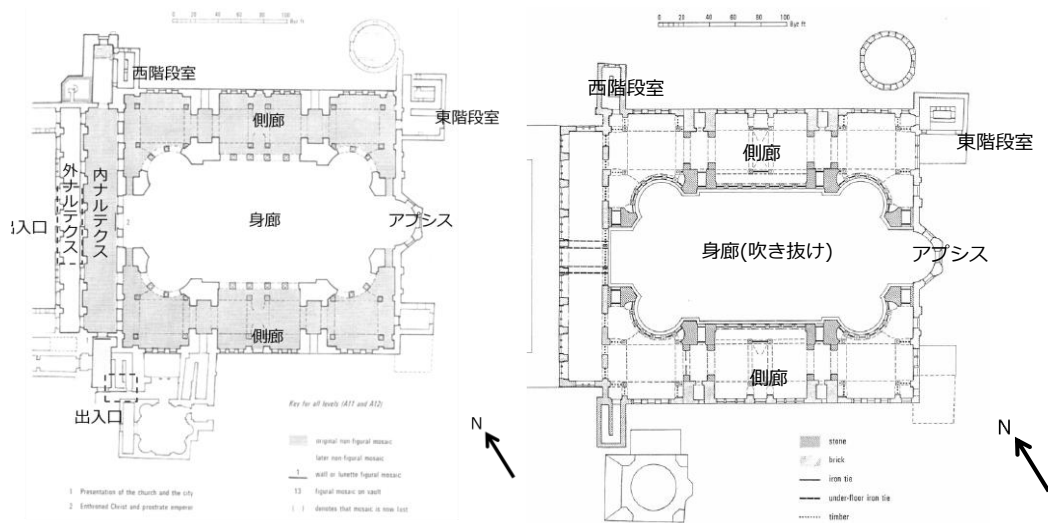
地上階平面図および各部名称^[2-1] 図 2.3 ギャラリー階平面図^[2-1]
